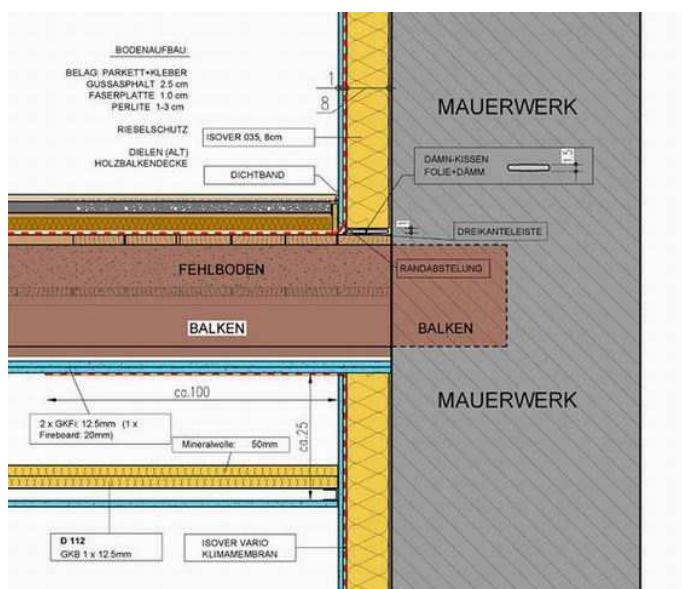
Querschnitt eines tragenden Balkens im Mauerwerk
